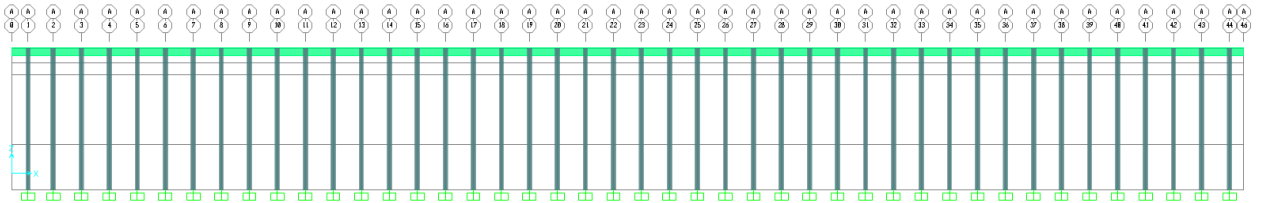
Vista en elevación del plano A de modelación, paralelo a plano X-Vertical.
